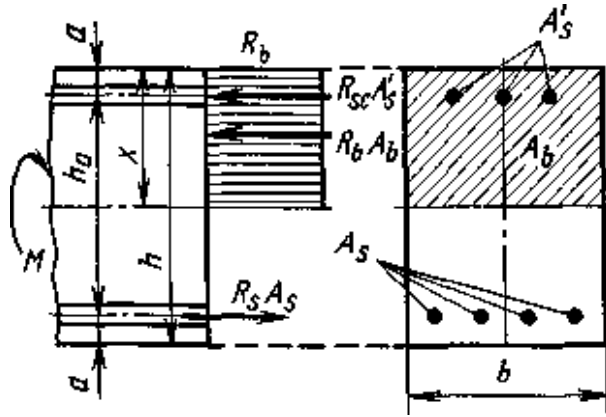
Розрахункова схема внутрішніх зусиль для елемента, що згинається, з подвійною арматурою
